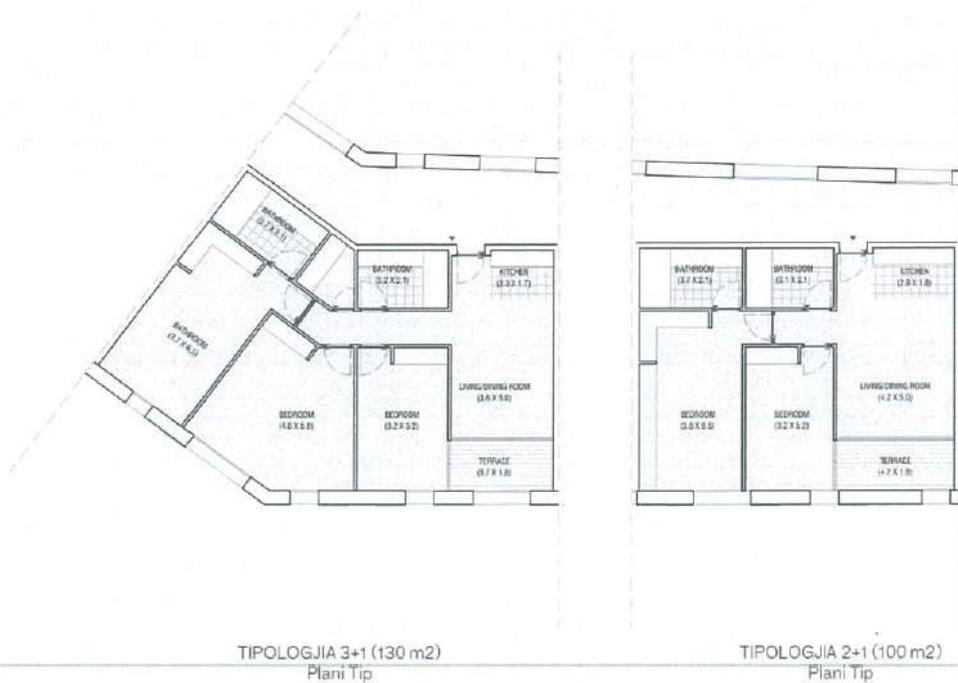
Plani i apartamenteve 3+1, 2+1
